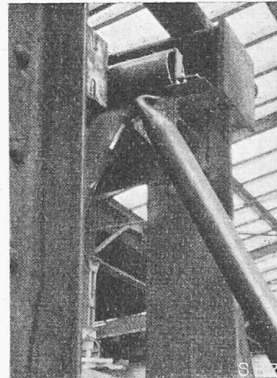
Falten der Enddiagonale des Versuchsträgers (Schweissanschluss) beim zweiten Belastungsversuch
